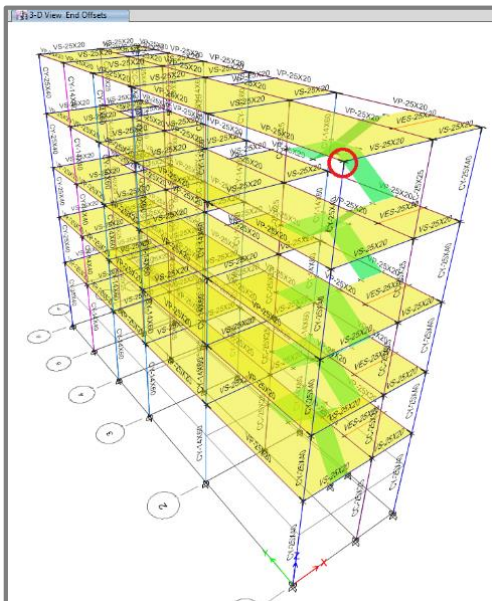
Todos los elementos vigas columnas en su intersección quedaron infinitamente rígidos
